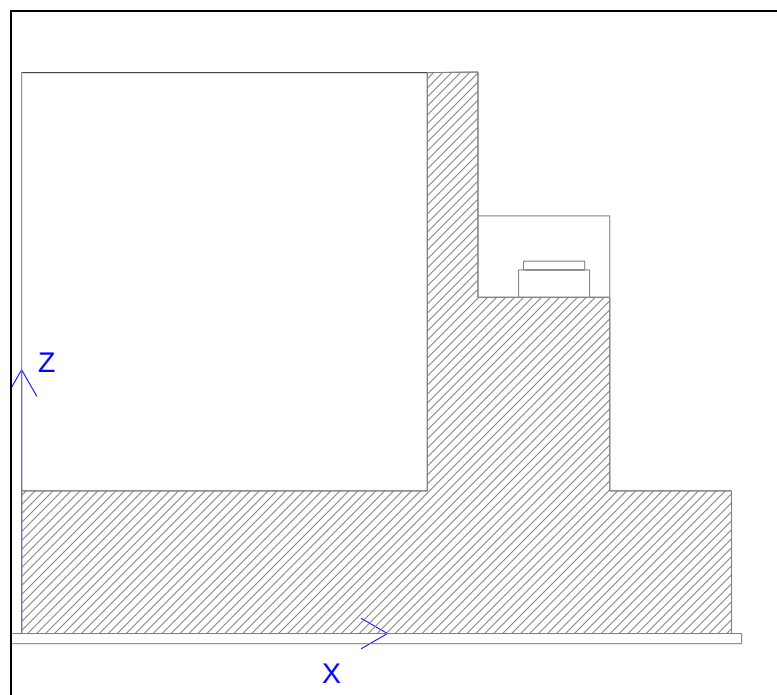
Spalla A - -Sistema di riferimento adottato per muro andatore
